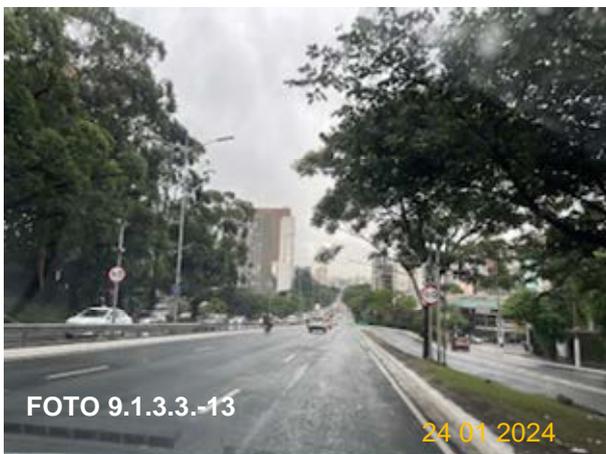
Trecho 23 de Maio. Córrego Boa Vista.
